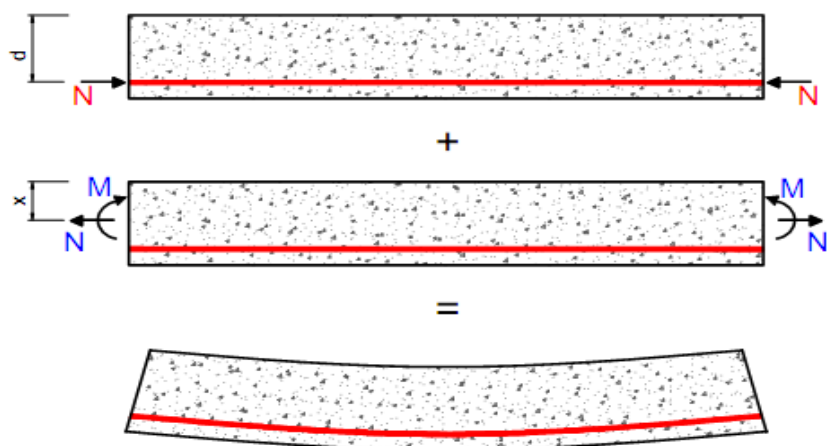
Exemplo do efeito da retração numa viga de betão armado
